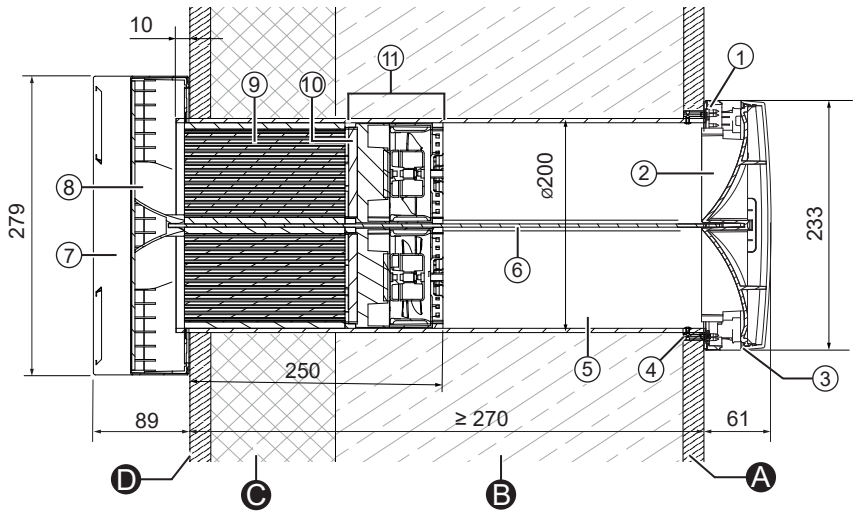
Disegno in sezione dell'unità di ventilazione iV-Twin+ (vista dall'alto)
